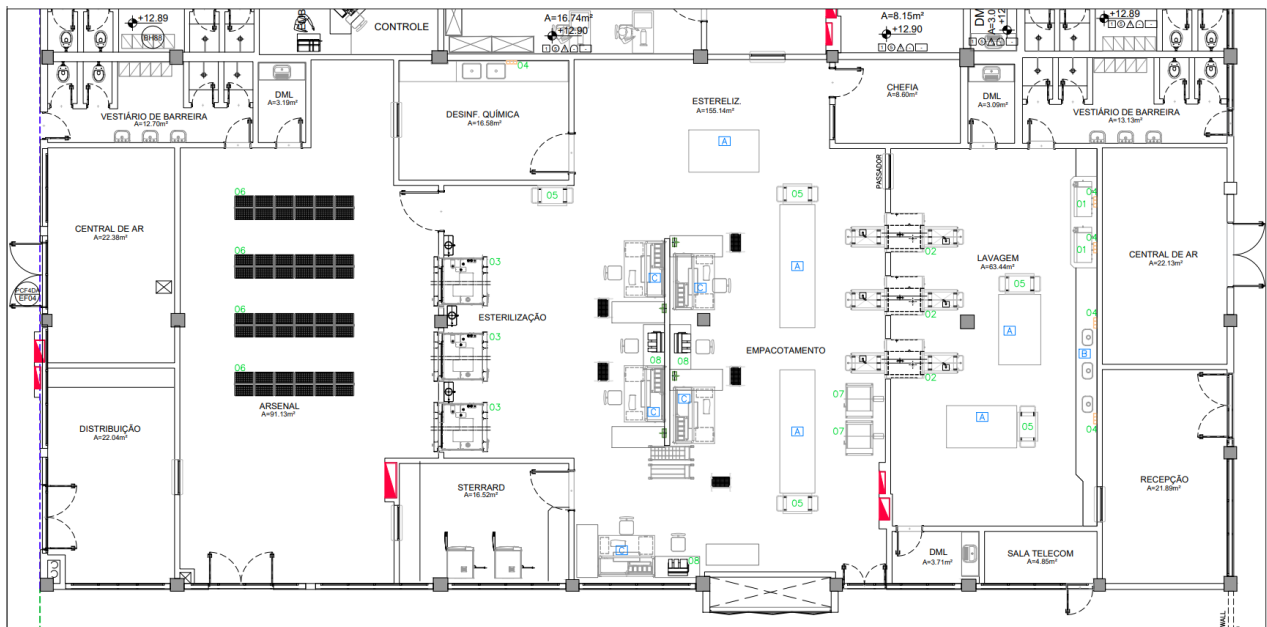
Planta baixa do CPME do HU-UNIFAP
